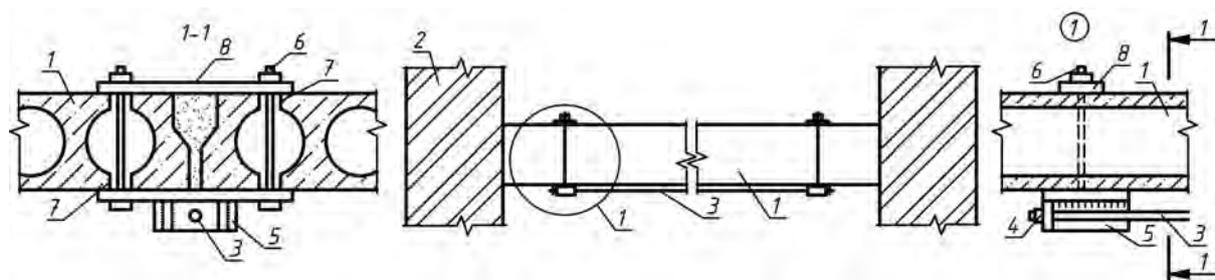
Установка затяжек: 1 – усиливаемая плита; 2 – несущие стены здания; 3 – затяжное устройство из арматуры; 4 – натяжная гайка; 5 – анкерное приспособление; 6 – крепежный элемент анкерного устройства с шайбой и гайкой; 7 – отверстия, просверленные в плите; 8 – поперечная планка
